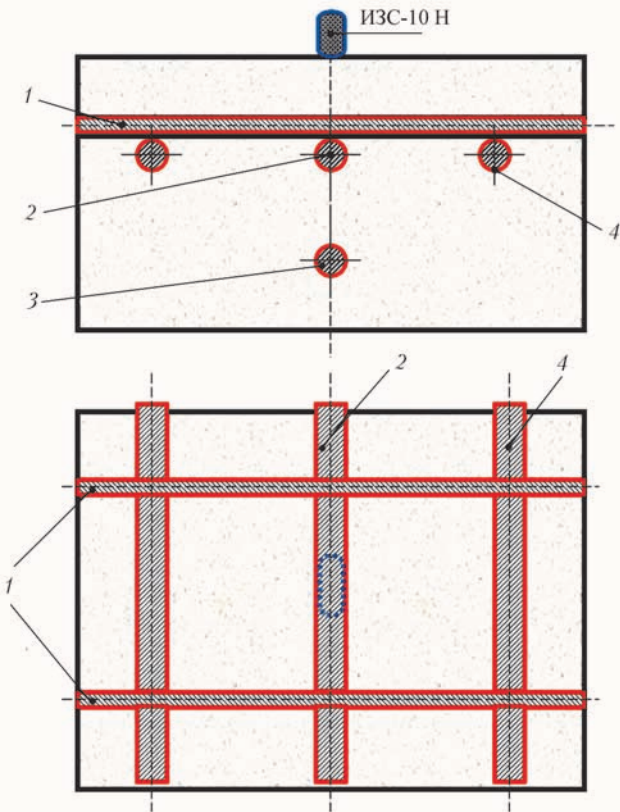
Визначення характеристик армування залізобетону для схеми перехресного армування конструкції: 1 – поперечний стрижень арматури; 2 – поздовжній арматурний стрижень, для якого визначають товщину захисного шару бетону; 3 – поздовжній арматурний стрижень другого ряду арматури; 4 – сусідні поздовжні стрижні арматури першого ряду арматури
